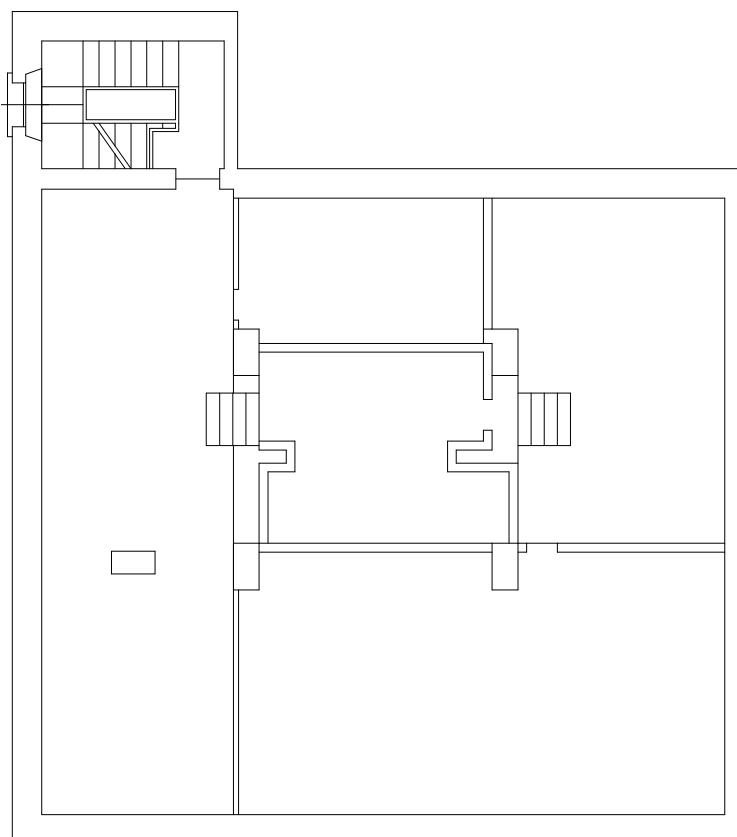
Planimetria del piano sottotetto del vecchio municipio
